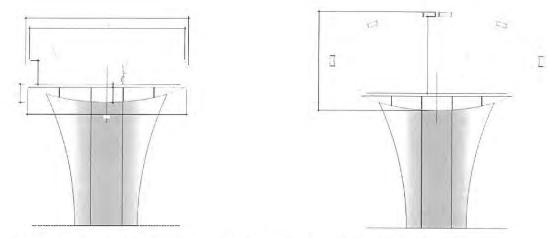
Secciones transversales de la propuesta arquitectónica y estructural.
